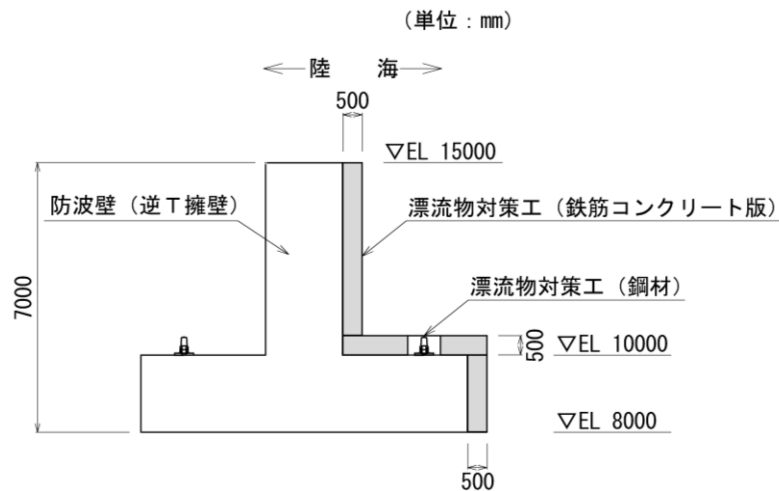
(3) 漂流物対策工 (鉄筋コンクリート版) の構造概要図 (断面図)
